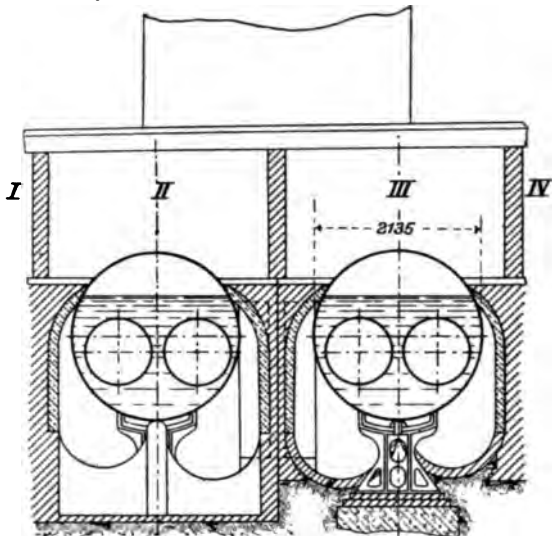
Grundriss der Livet'schen Kesseleinmauerung.
